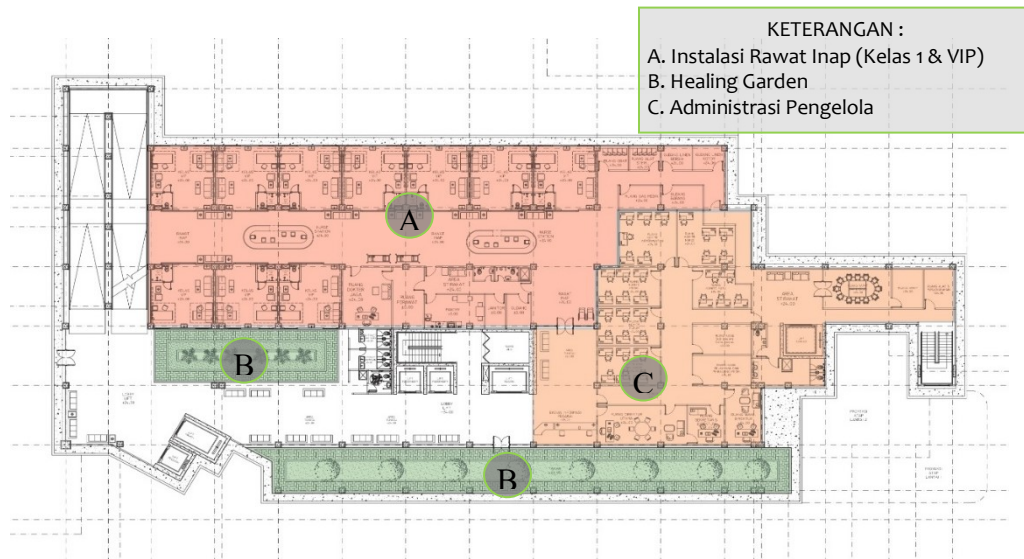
Konsep Ruang Lantai 3 (Sumber : Penulis, 2023)
